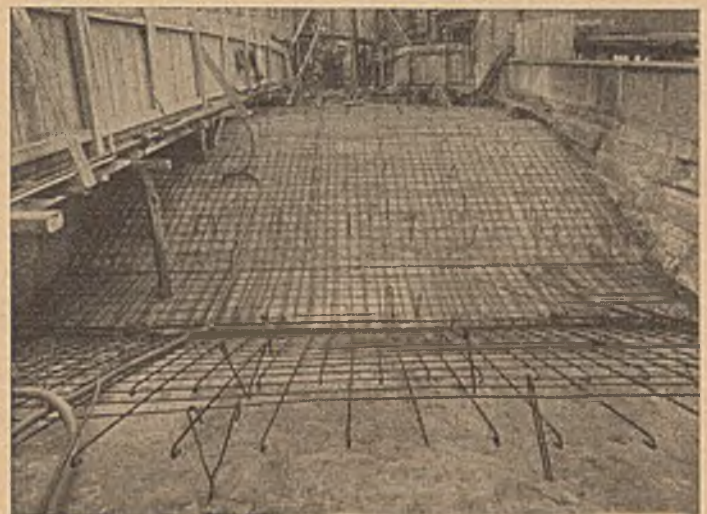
Torkretschalenarmierung auf dem Gewölberücken.
